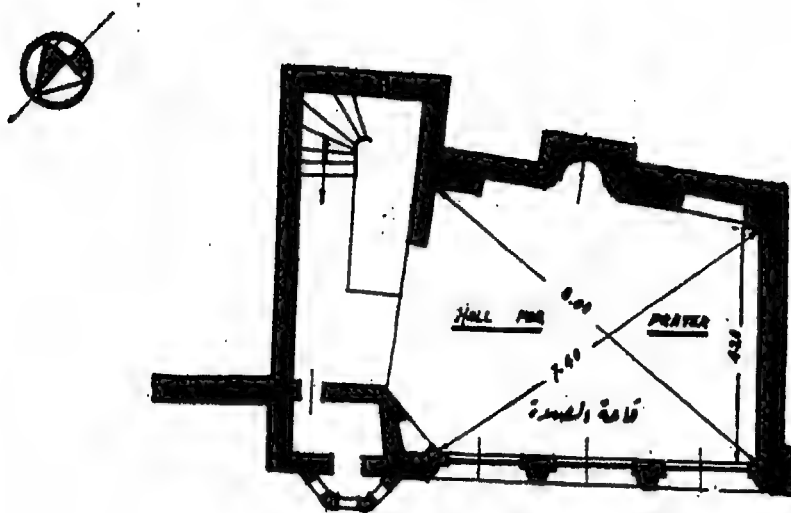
مسقط أفقى لجامع الغريب خلف مستشفى الحسين الجامعى.
